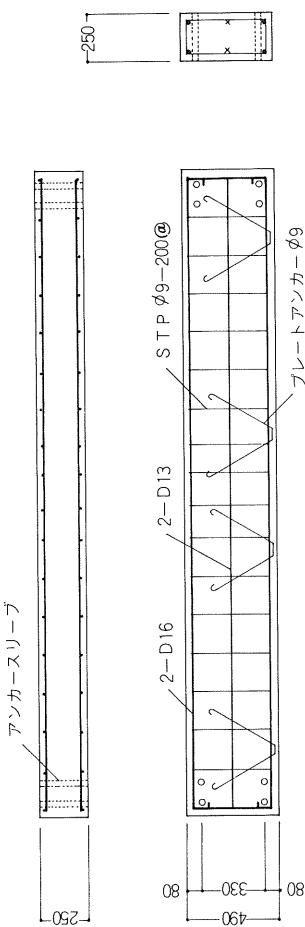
天井PC版(S P<sub>1</sub>)配筋図 1/40
